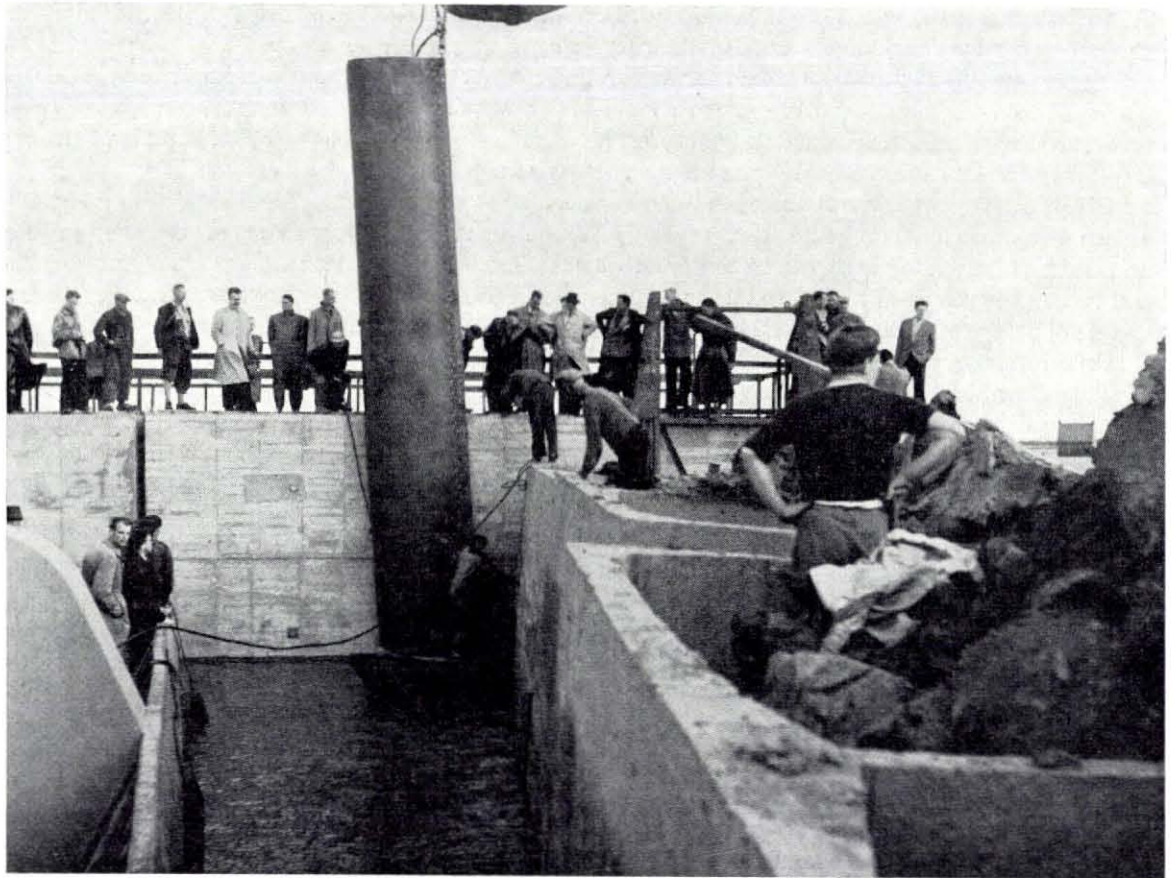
Aanbrengen van een rubberworst voor afdichting tussen de aanslagen van de westelijke sluitcaisson en de pijlercaisson bij de blokkering van het gat bij de Veerhaven te Kruiningen op 23 juli 1953 Foto Stuvet
